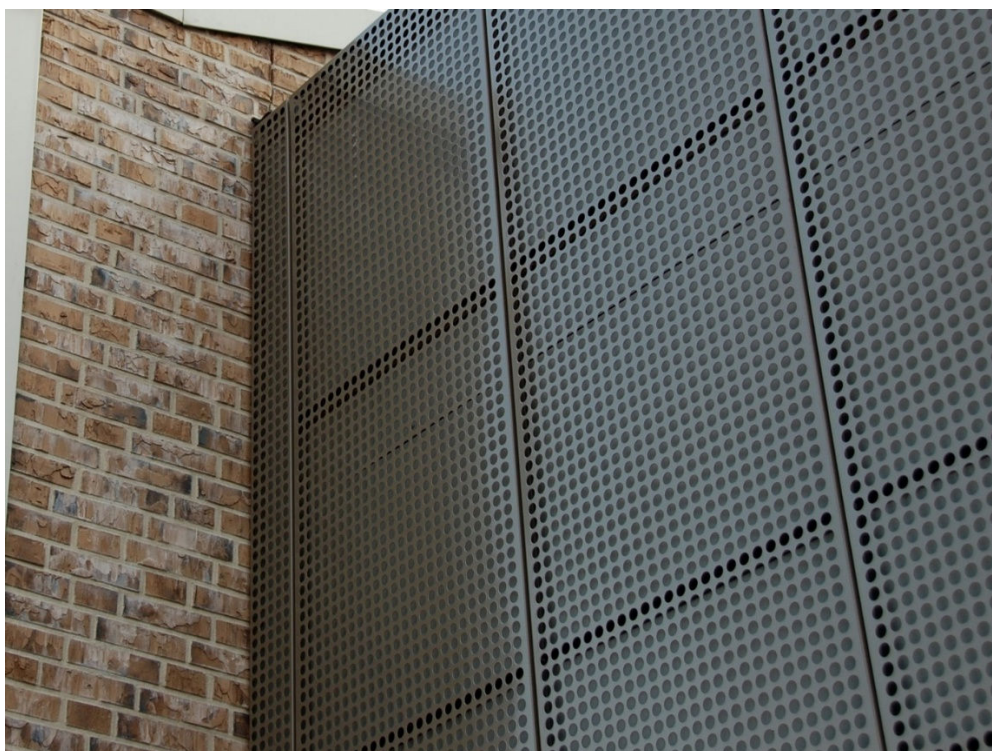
Voorbeeld open beplating voor afwerking bordessen
